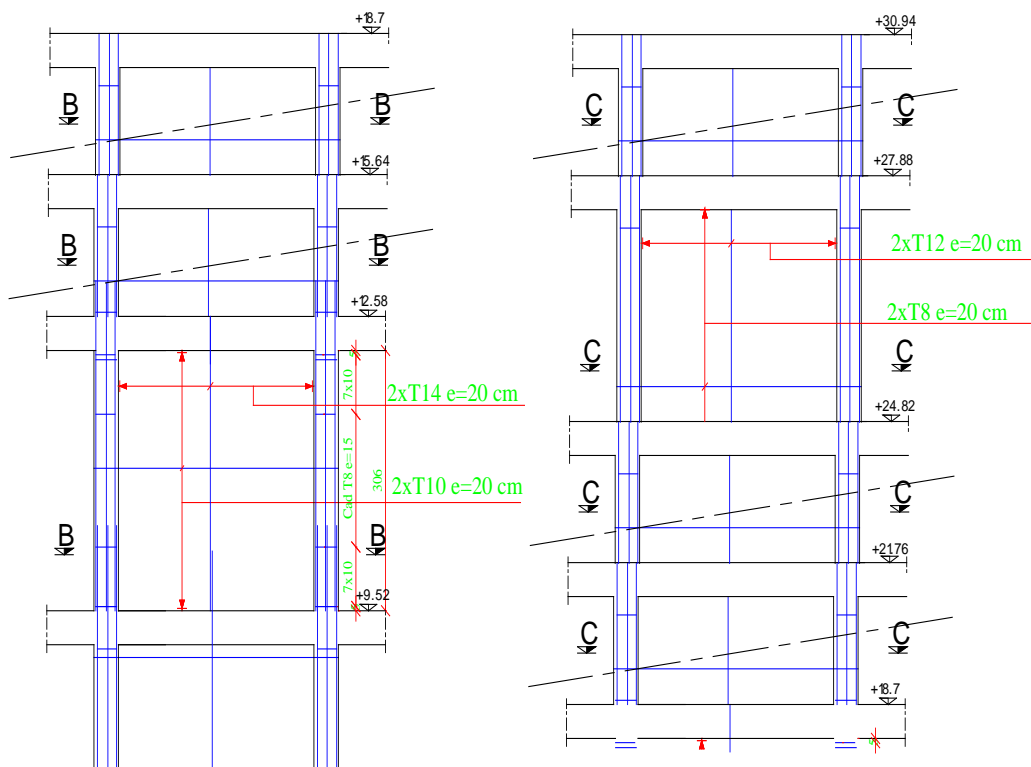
ferrailage coupe des voiles 02 (RDC, 1^{er} et 2^{ème} étages)/Figure (V.12) : ferrailage coupe des voiles 02 (3^{ème}, 4^{ème} et 5^{ème} étages)
